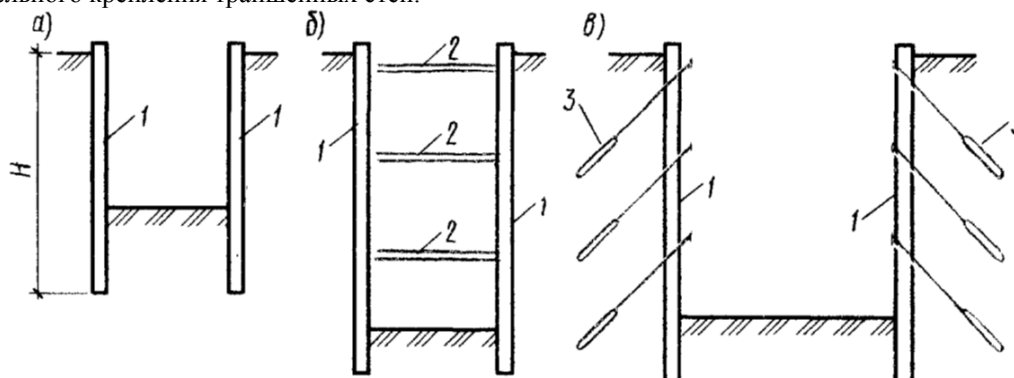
Конструктивные схемы сооружения с параллельными стенами: а – консольная стена; б – стены с креплением распорками; в – стены с креплением анкерами. 1 – стена, 2 – распорка, 3 – анкер, H – глубина заложения стены
